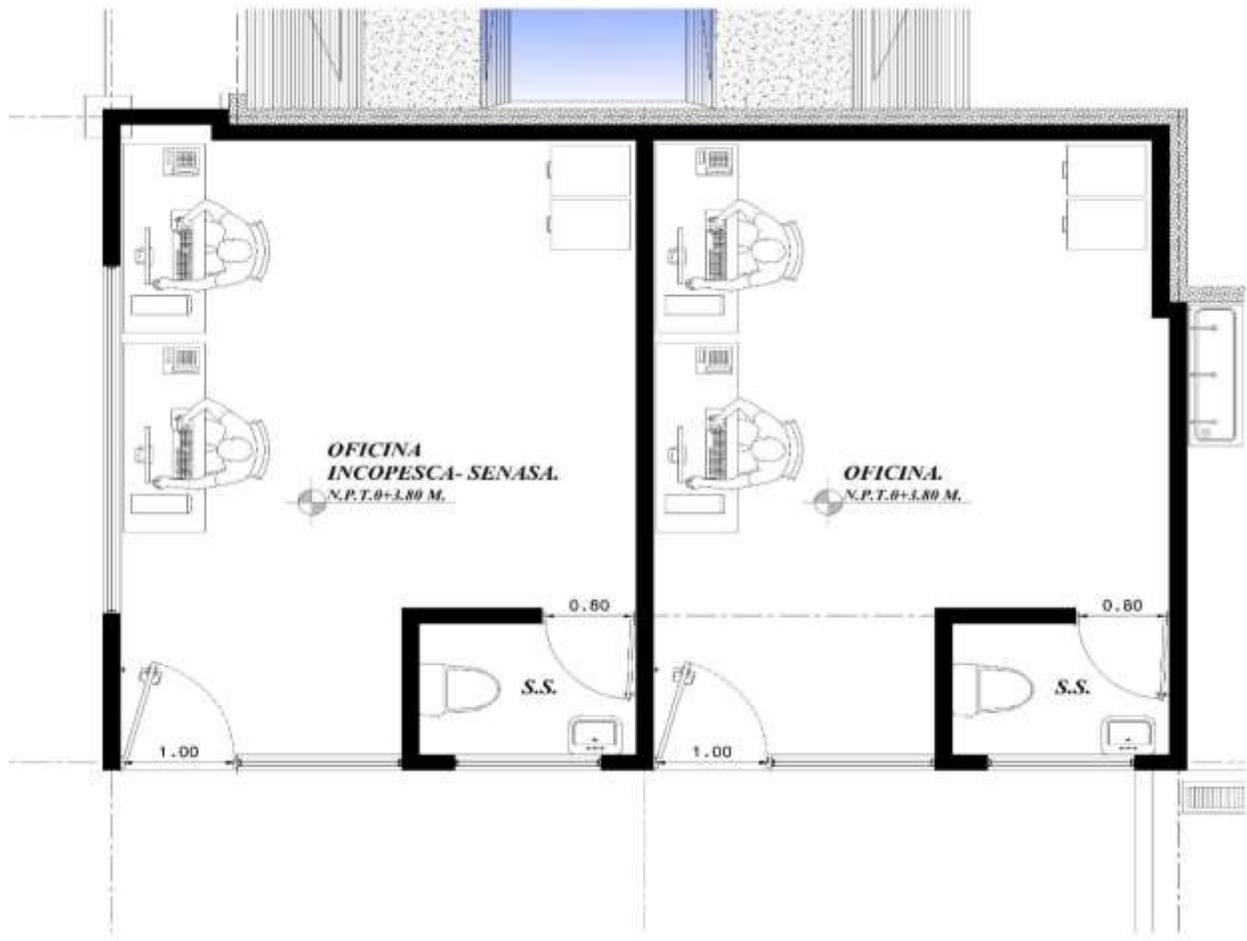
Planta de distribución de oficinas para SENASA e INCOPESCA
